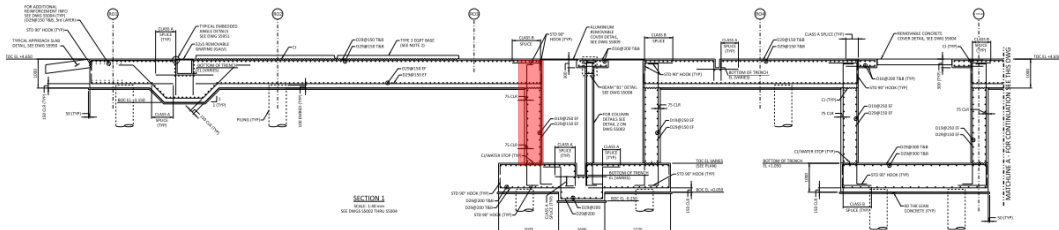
13 Penggunaan Water Stop pada Pengecoran Pondasi RO Building
